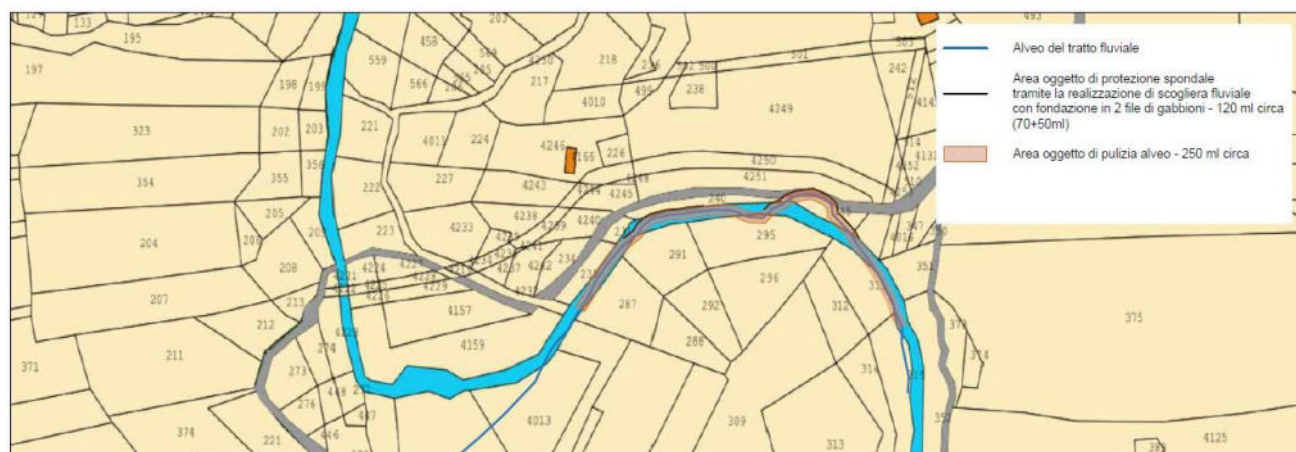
Planimetria catastale con tratto fluviale interessato dalle opere
